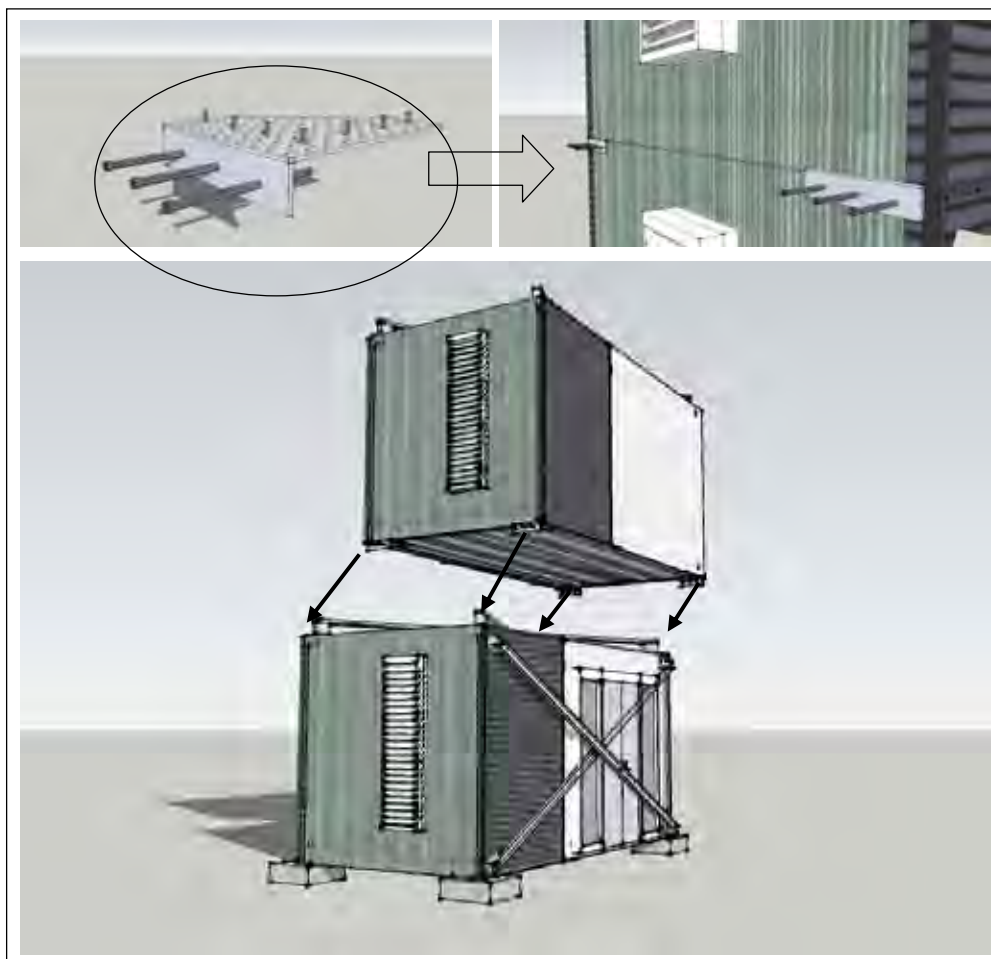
Apilamiento del Módulo. Fuente: Internet 2008.
